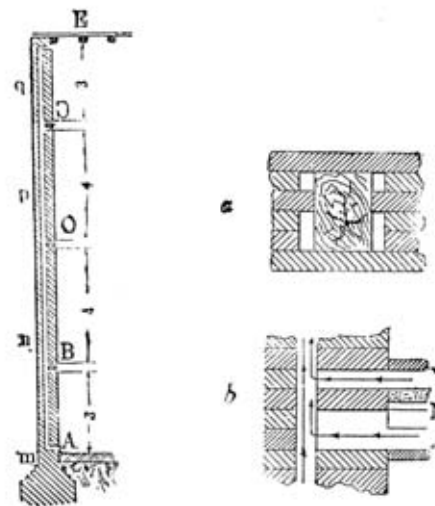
Il sistema a "parete ventilata" progettato alla fine dell'Ottocento dall'ingegnere Janssen per case d'affitto ad Amburgo. Sezione e particolare dell'appoggio ventilato delle travi in legno (da Spataro).
